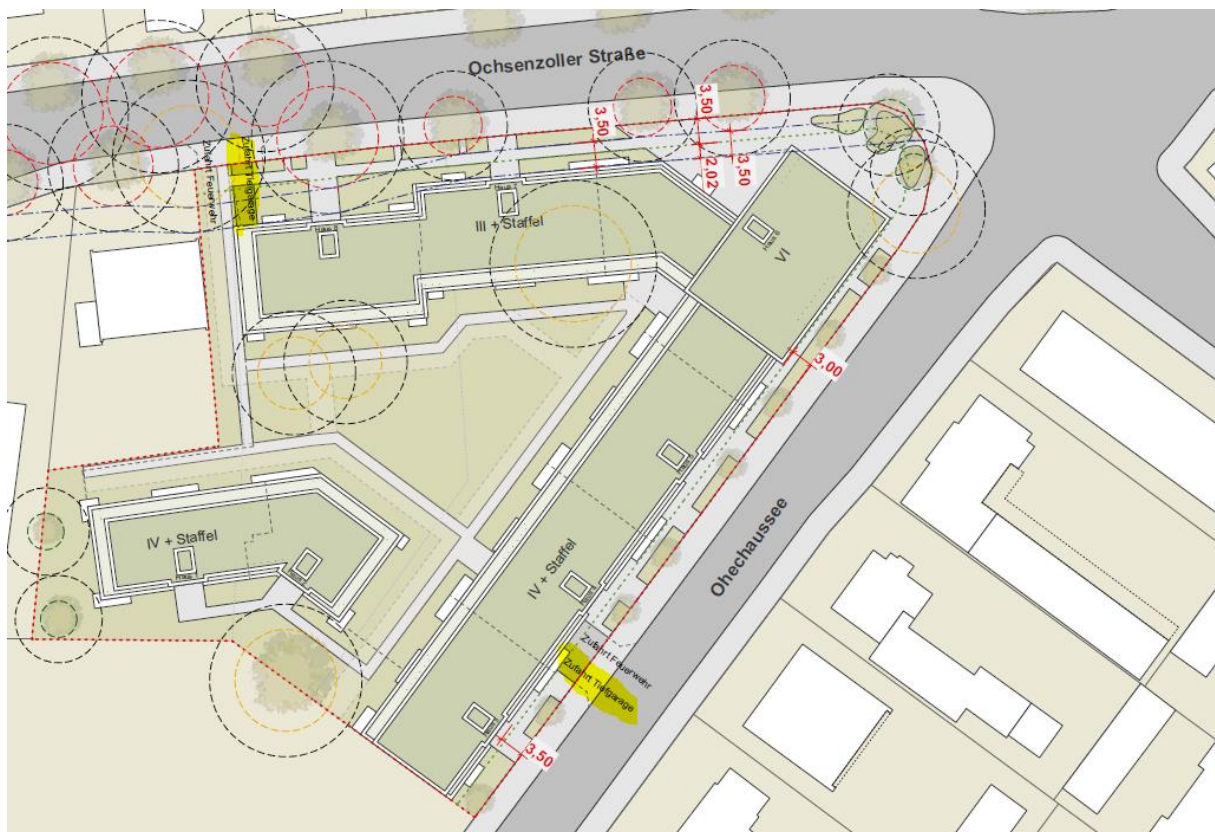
Lageplan mit markierten Tiefgaragenzufahrten
